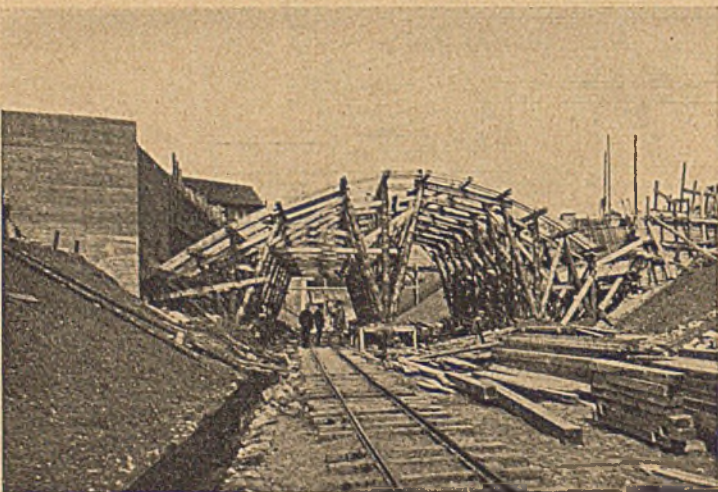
Lehrgerüst mit 2 Durchfahrtsöffnungen.
